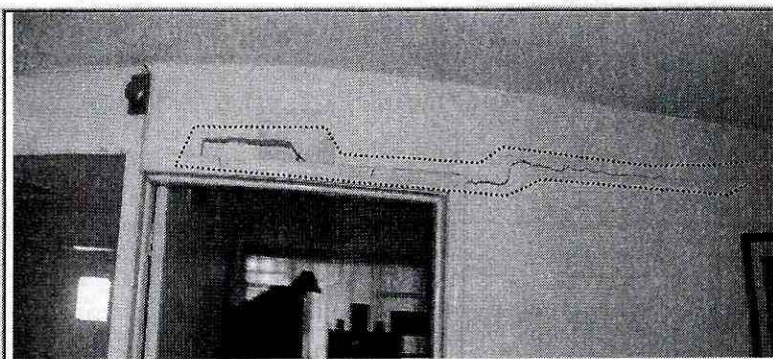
Se observan fisuras y grietas sobre los muros internos del segundo piso de la vivienda.
